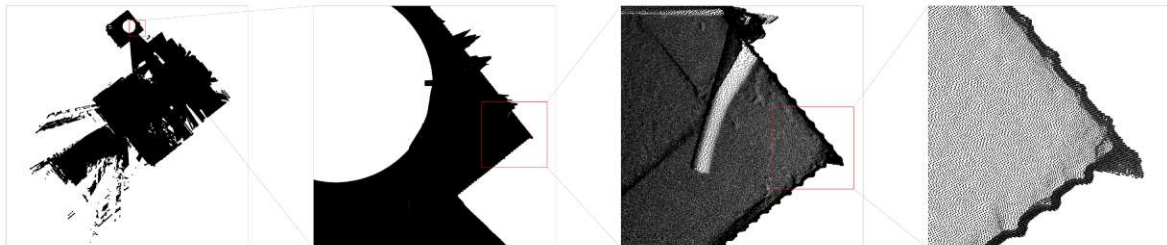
Ansicht der Punktwolke im Grundriss (Schrittweiser Zoom).
